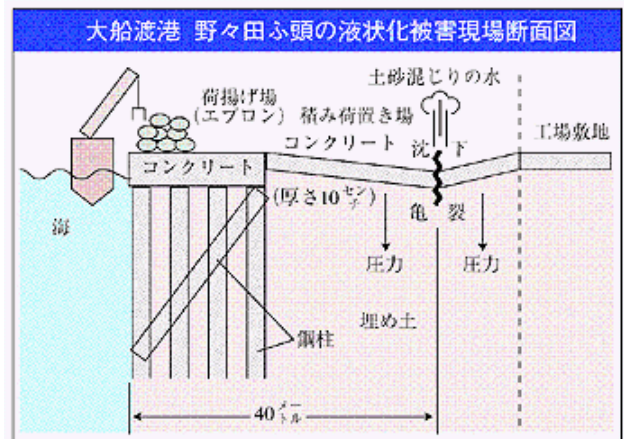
大船渡港野々田ふ頭岸壁の施工断面図
